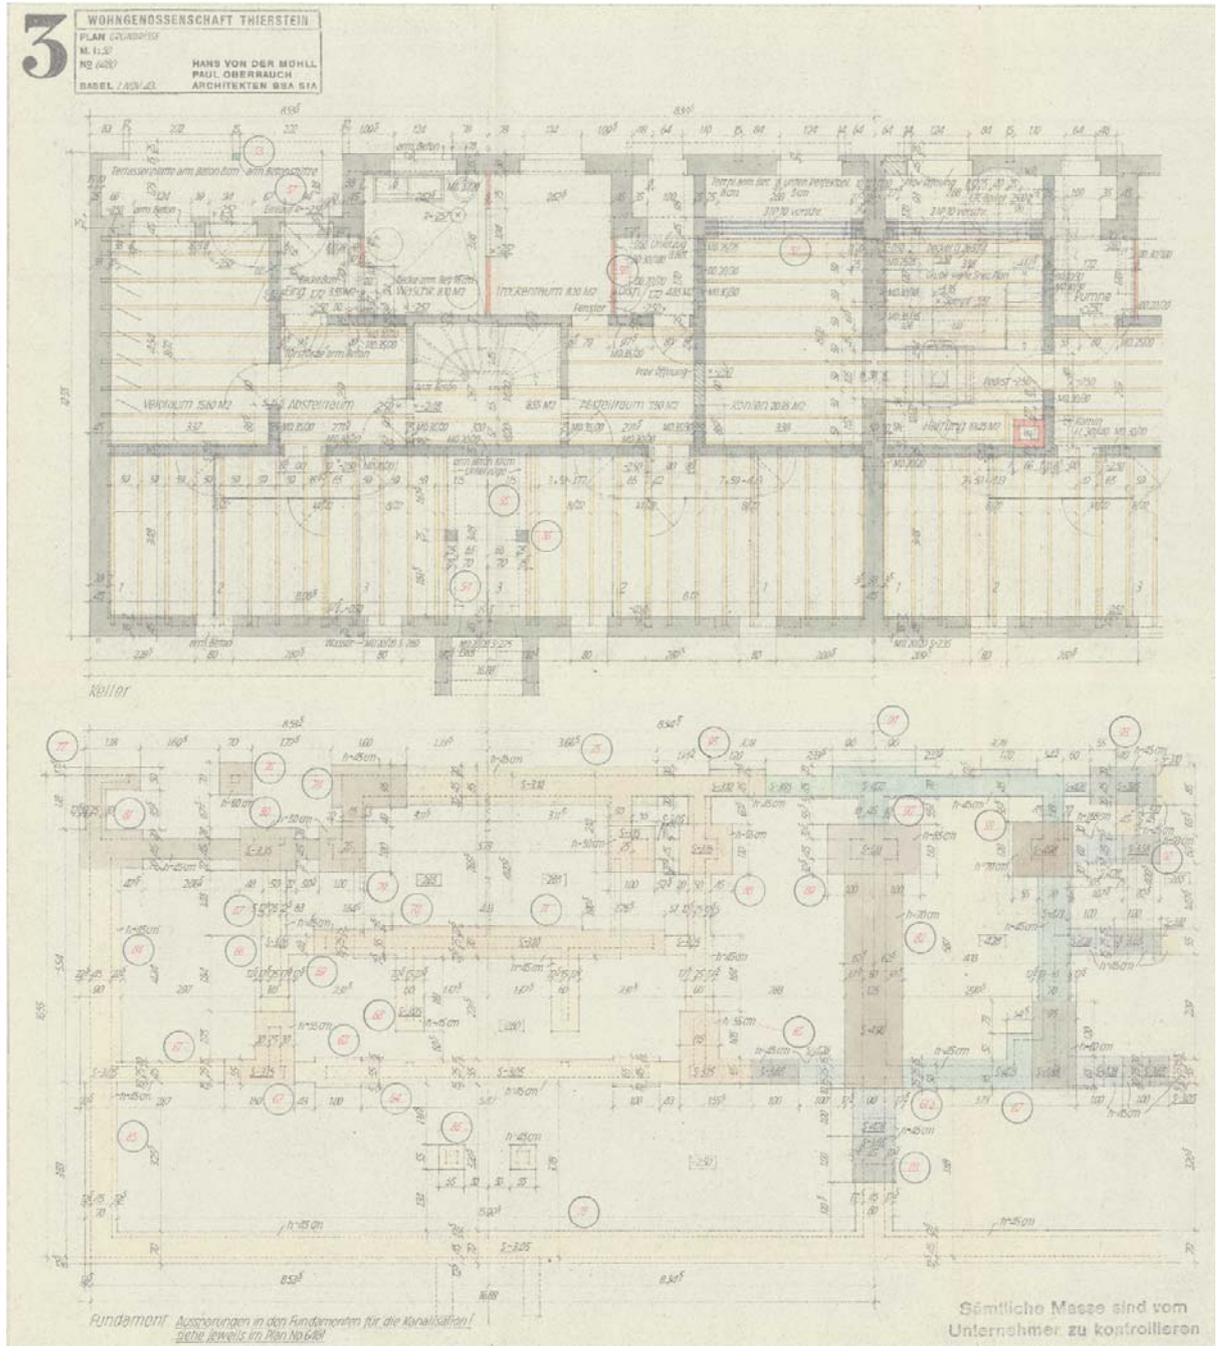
Keller (oben) und Fundament (unten), Plan 1:50, 1.Etappe, 1943 [Quelle: Architekturbüro von der Mühl und Oberrauch, 1943]
